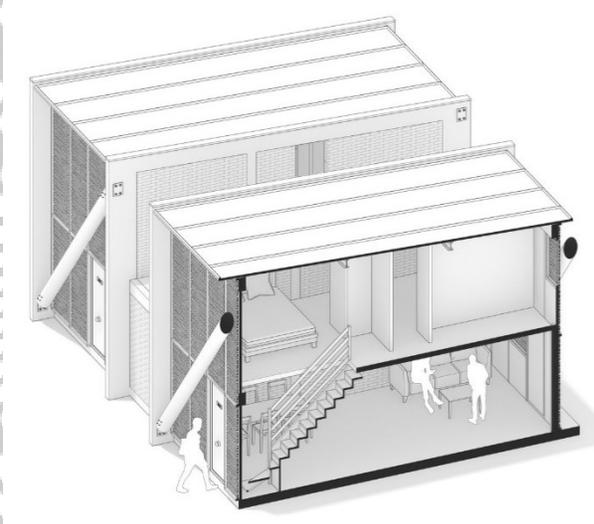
Casa con marco de hormigón armado, Chile (Arquitectos, 2013).
